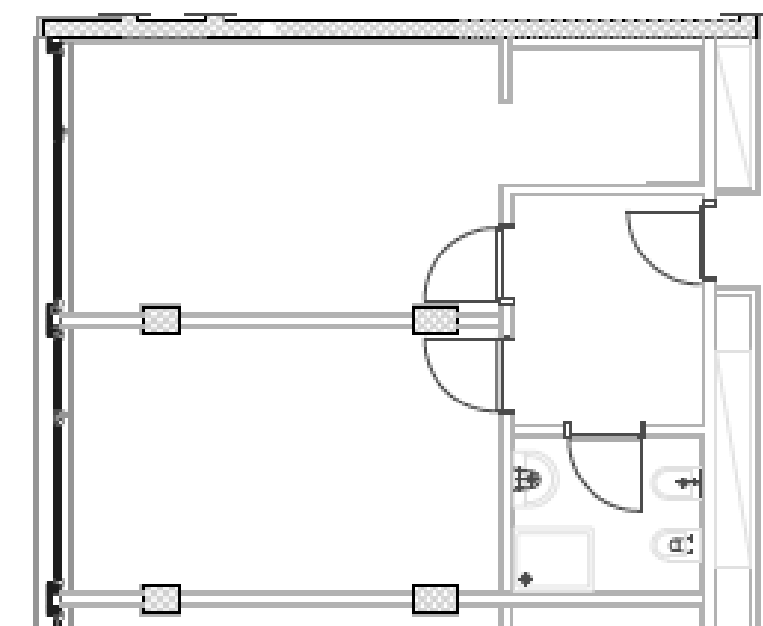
Pianta tipologia Platinum - Fonte: archivio In-Domus
